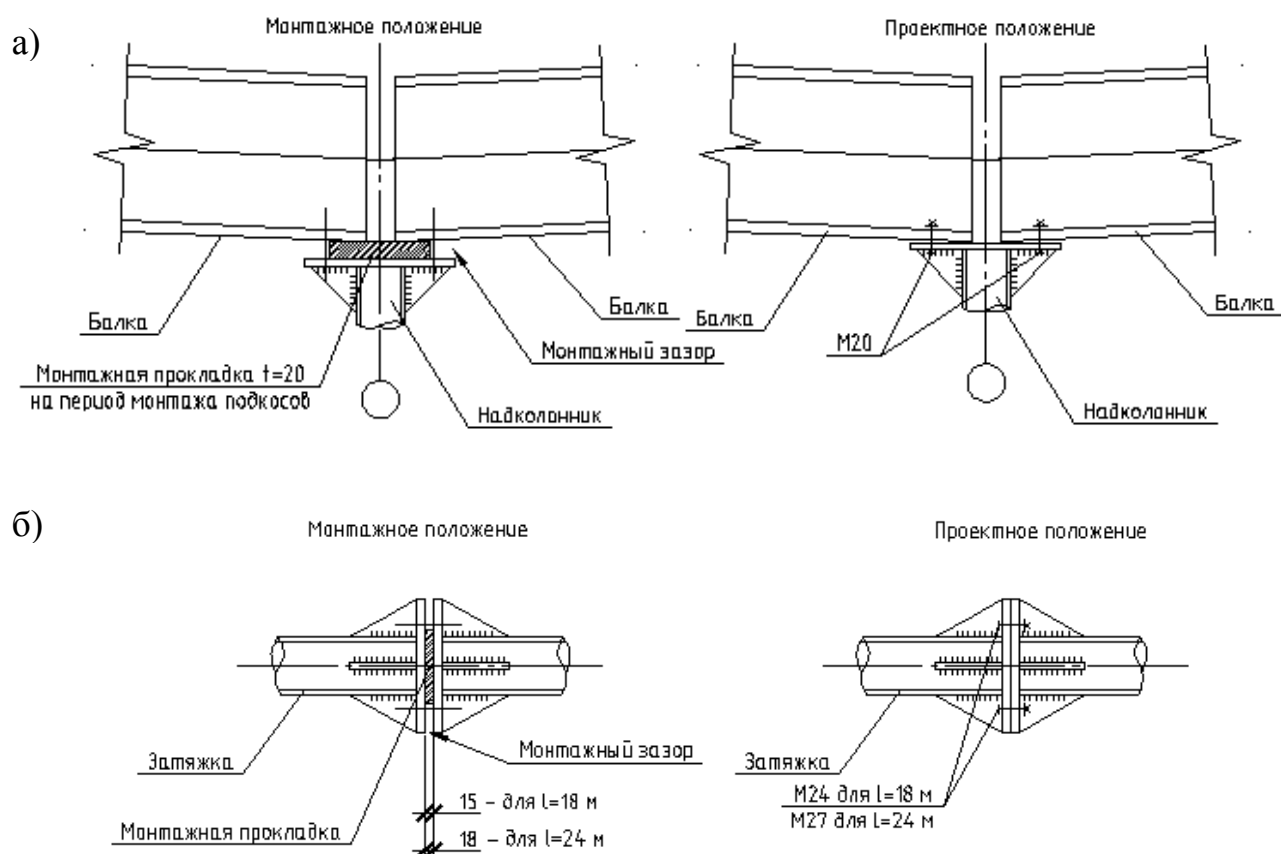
Создание предварительного напряжения в балках пролетами 18 и 24 м смыканием зазоров в монтажных стыках: а) надколонника с балкой; б) затяжки
